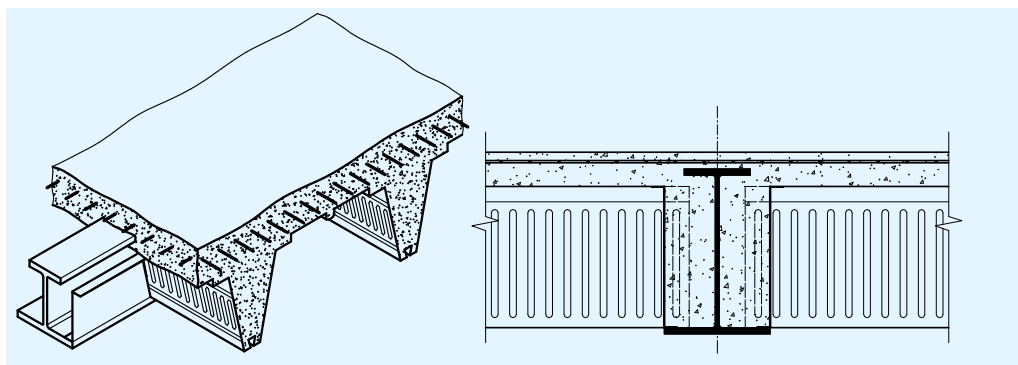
ASB – Viga integrada (viga de acero asimétrica laminada)
